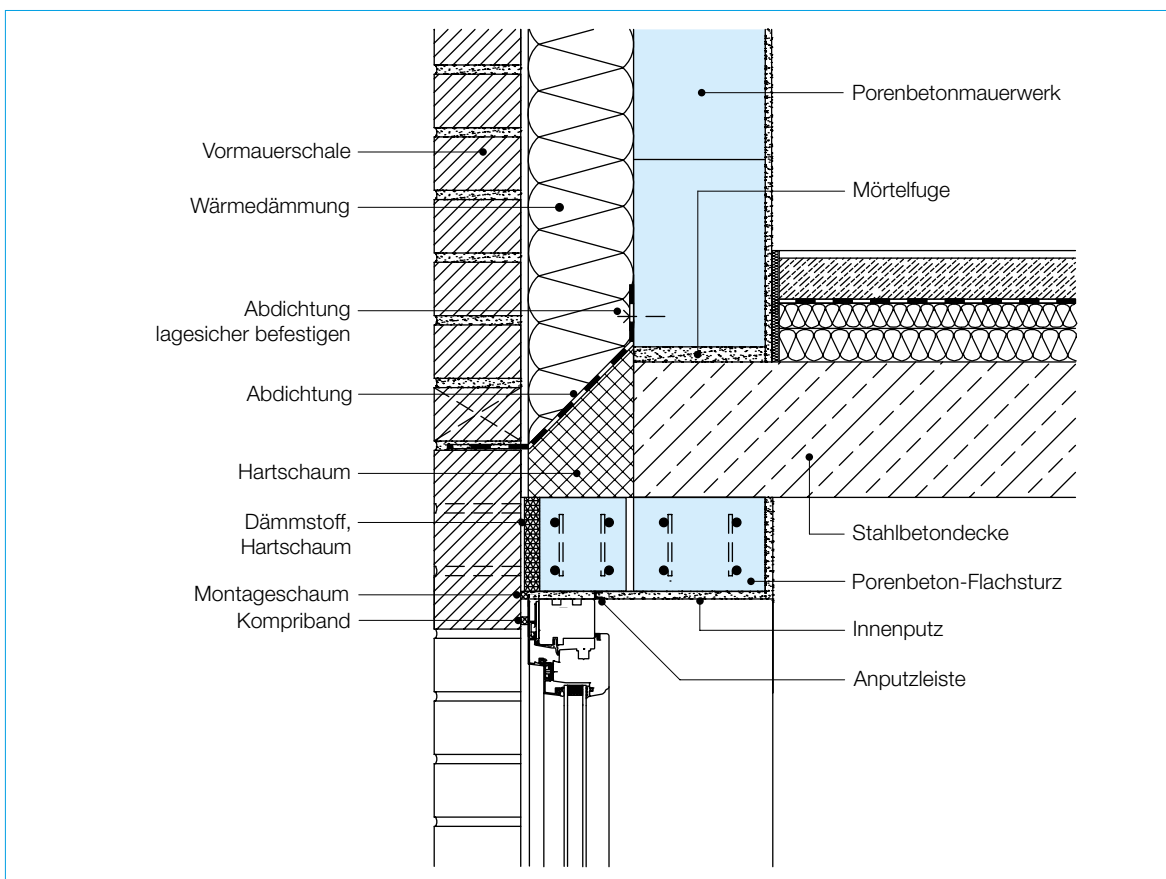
Zweischalige Außenwand aus Porenbetonmauerwerk mit Wärmedämmung und Vormauerschale – Anschluss an Stahlbetondecke und Fensteranschluss mit Porenbeton-Flachstürzen
